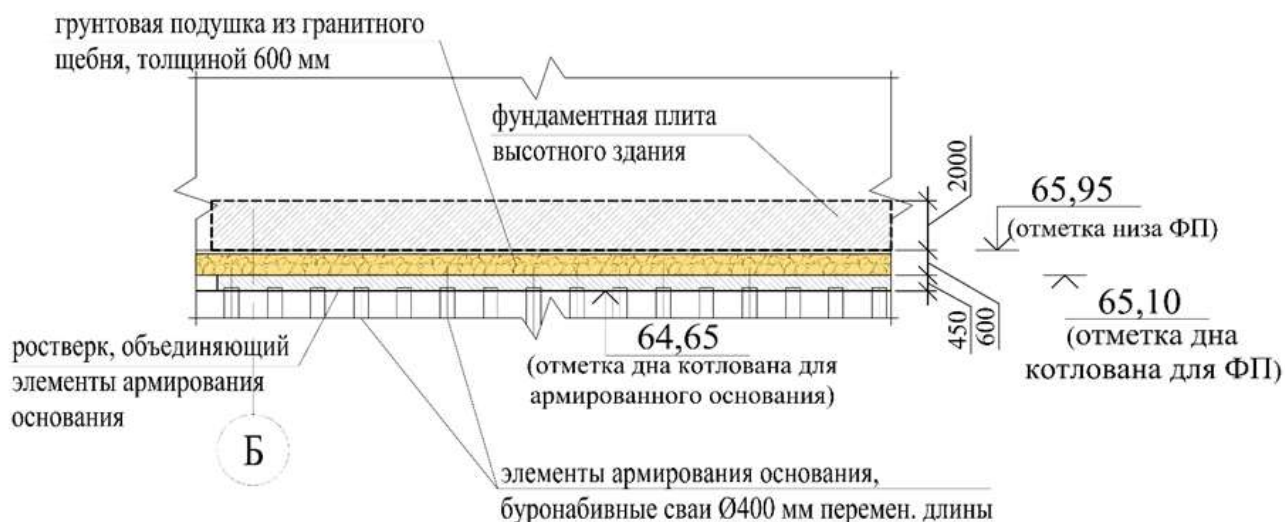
Техническое решение плитного фундамента на армированном основании для высотного здания в г. Сочи
